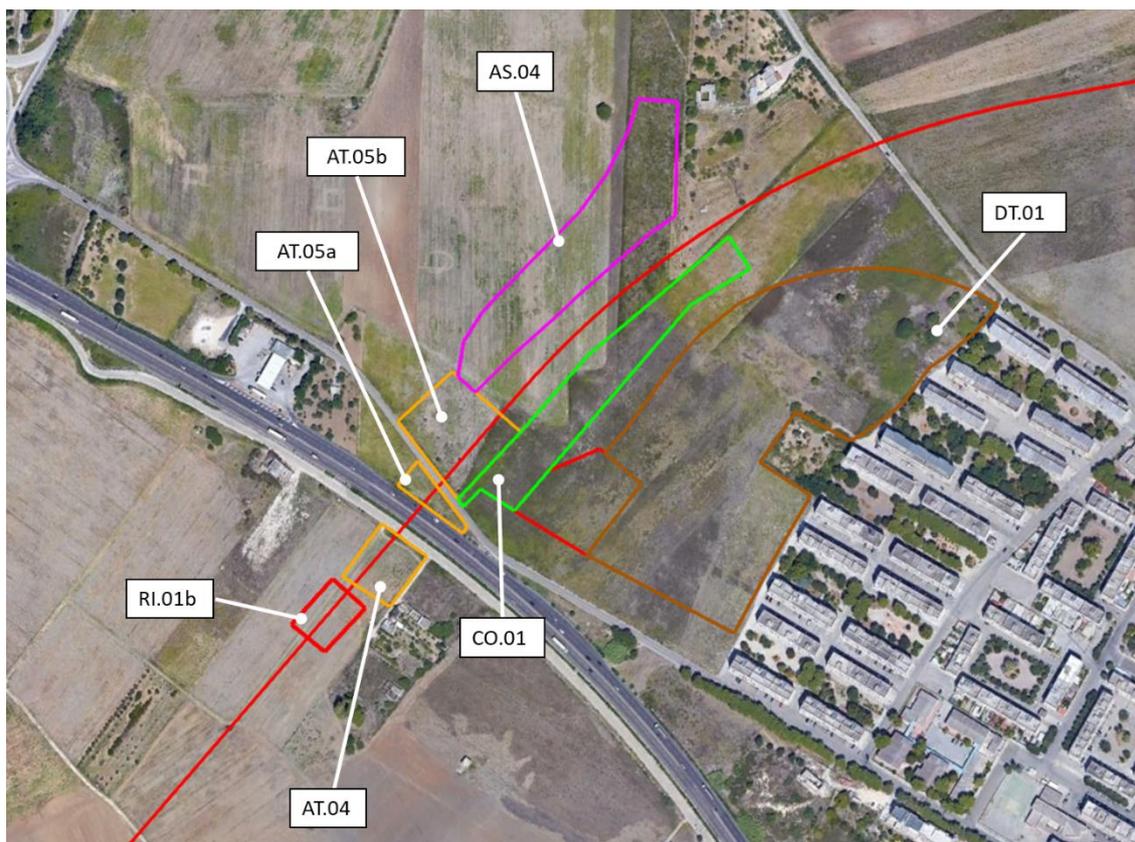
Aree di cantiere oggetto di modellazione in Aermid View (scenario1)
